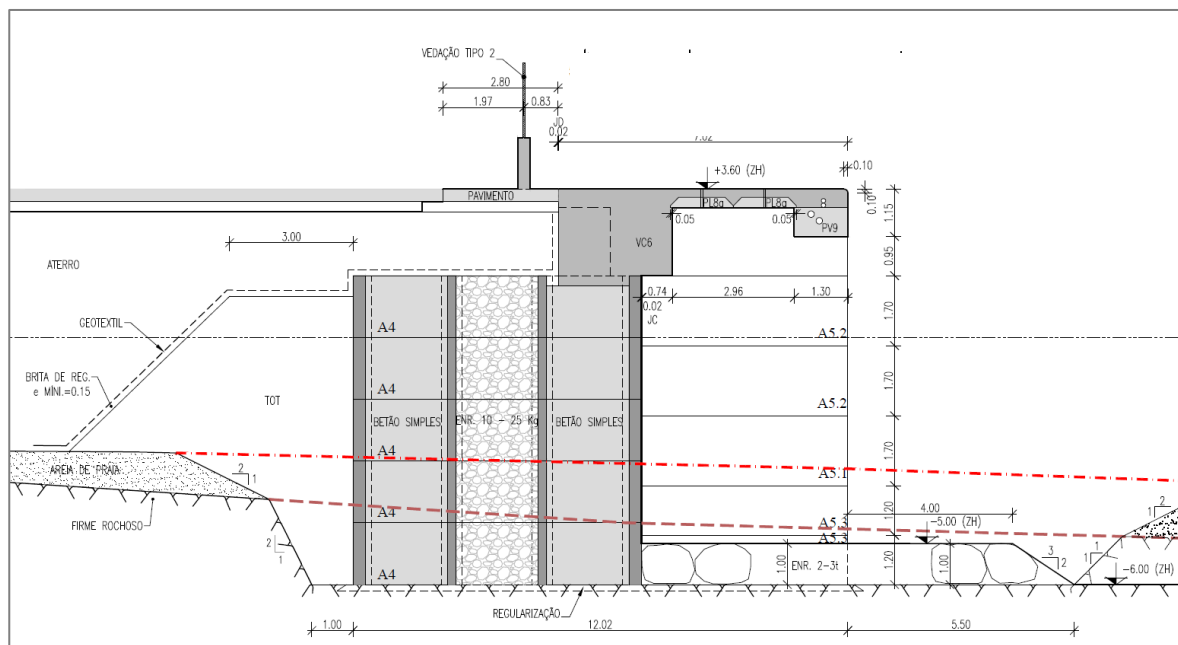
Obra de Abrigo Nascente - Perfil tipo da estrutura do troço central
